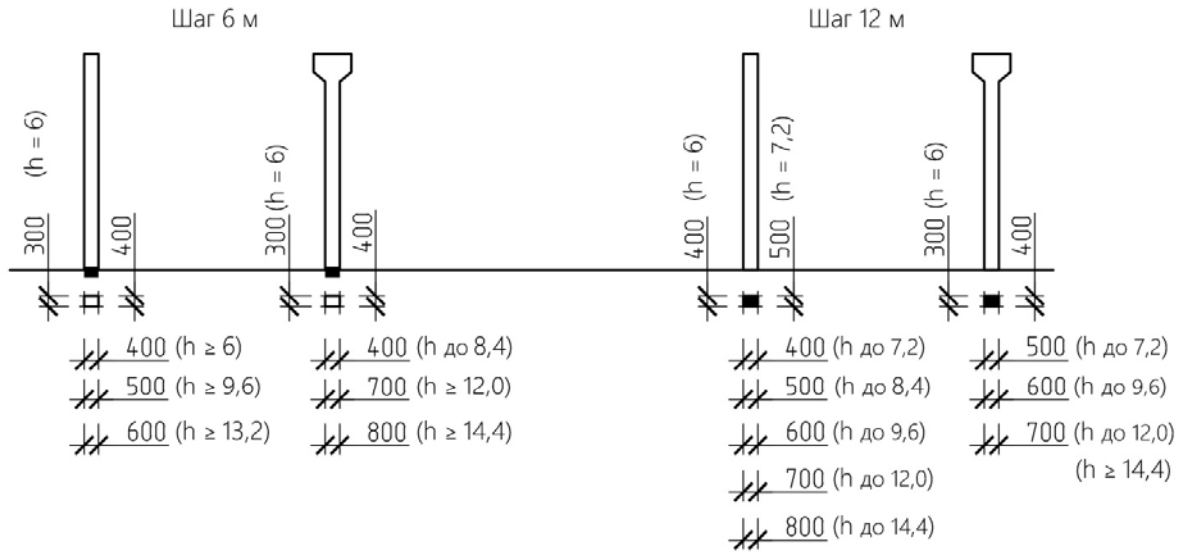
Железобетонные колонны сплошного сечения для зданий без опорных кранов
